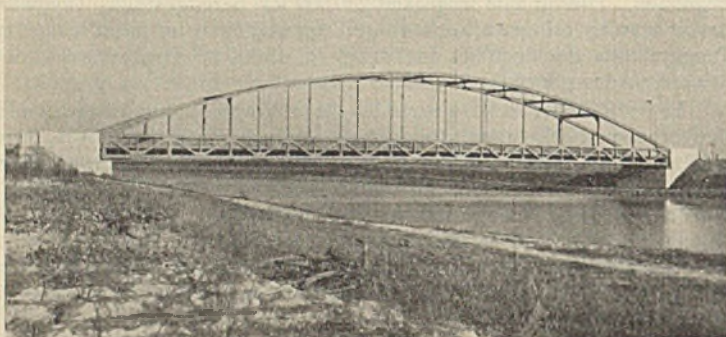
Kreisstraßenbrücke Walle-Veltenhof.
